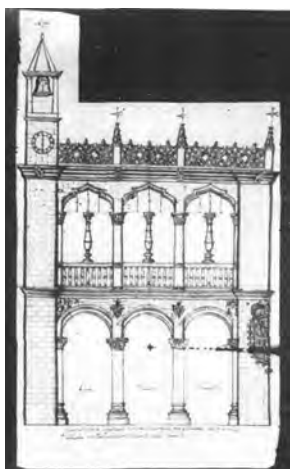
Varagaña. Fachada Ayuntamiento. Alzado de estado actual antes de su derribo.
